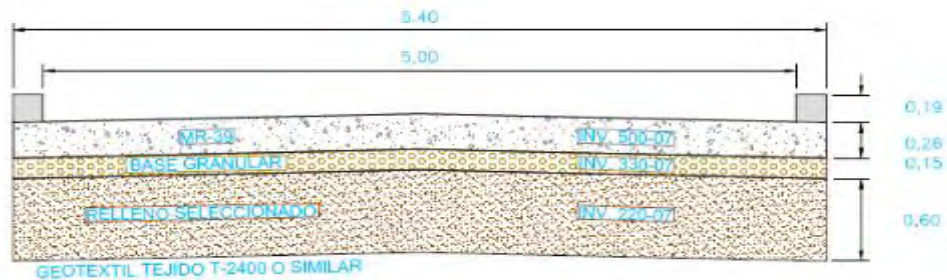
Sección transversal de la carrera 10 entre calles 6 y 8.
